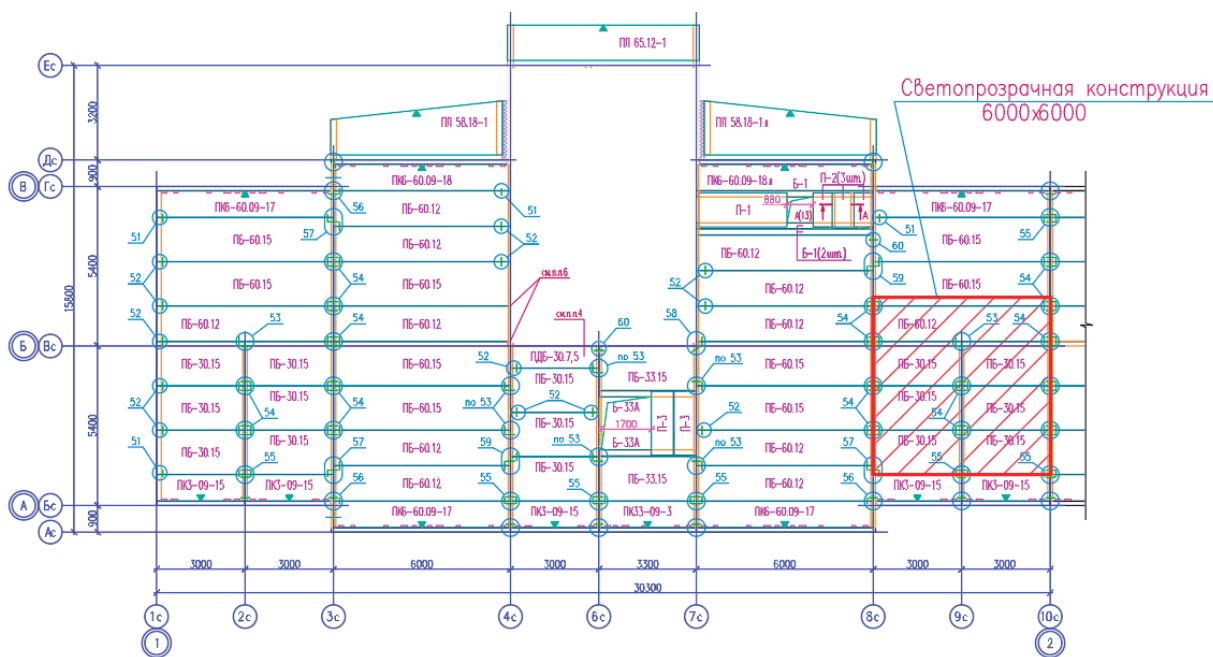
Схема расположения светопрозрачной оболочки на покрытии жилого дома
